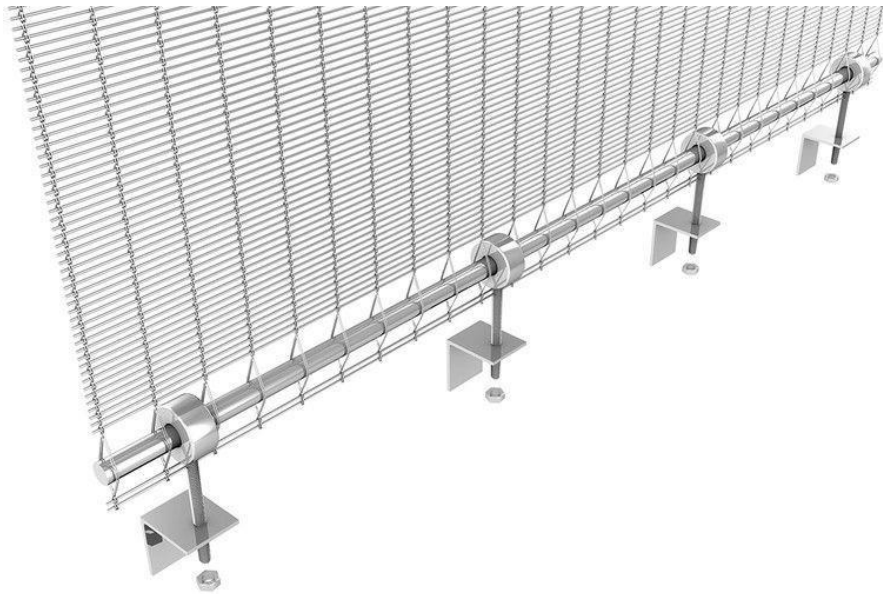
Sistema de fijación de malla Arquitectónica, Fuente:
